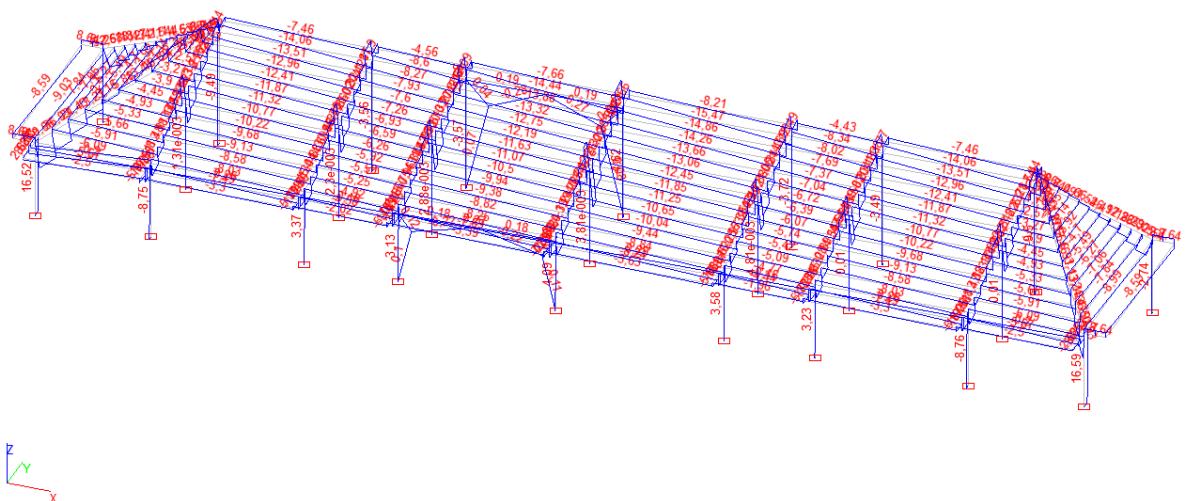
Эпюры и максимальные значения поперечных сил Q (кН) от расчетного сочетания нагрузок
